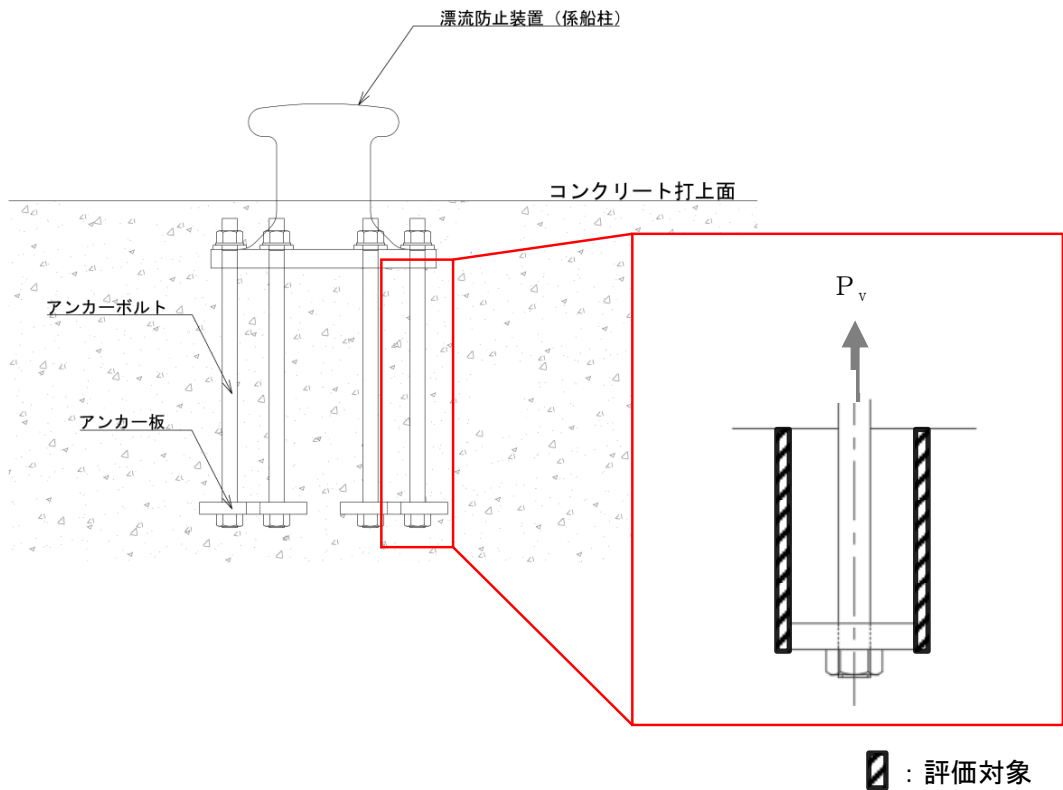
コンクリート（アンカーボルト側面）のモデル図
